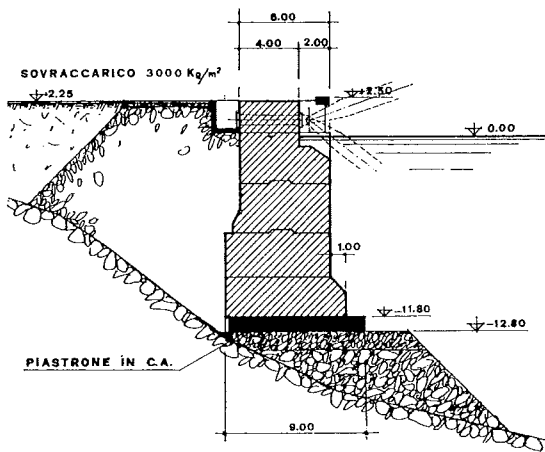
Banchina nel porto di Palermo con sottopiastra in c.a.
